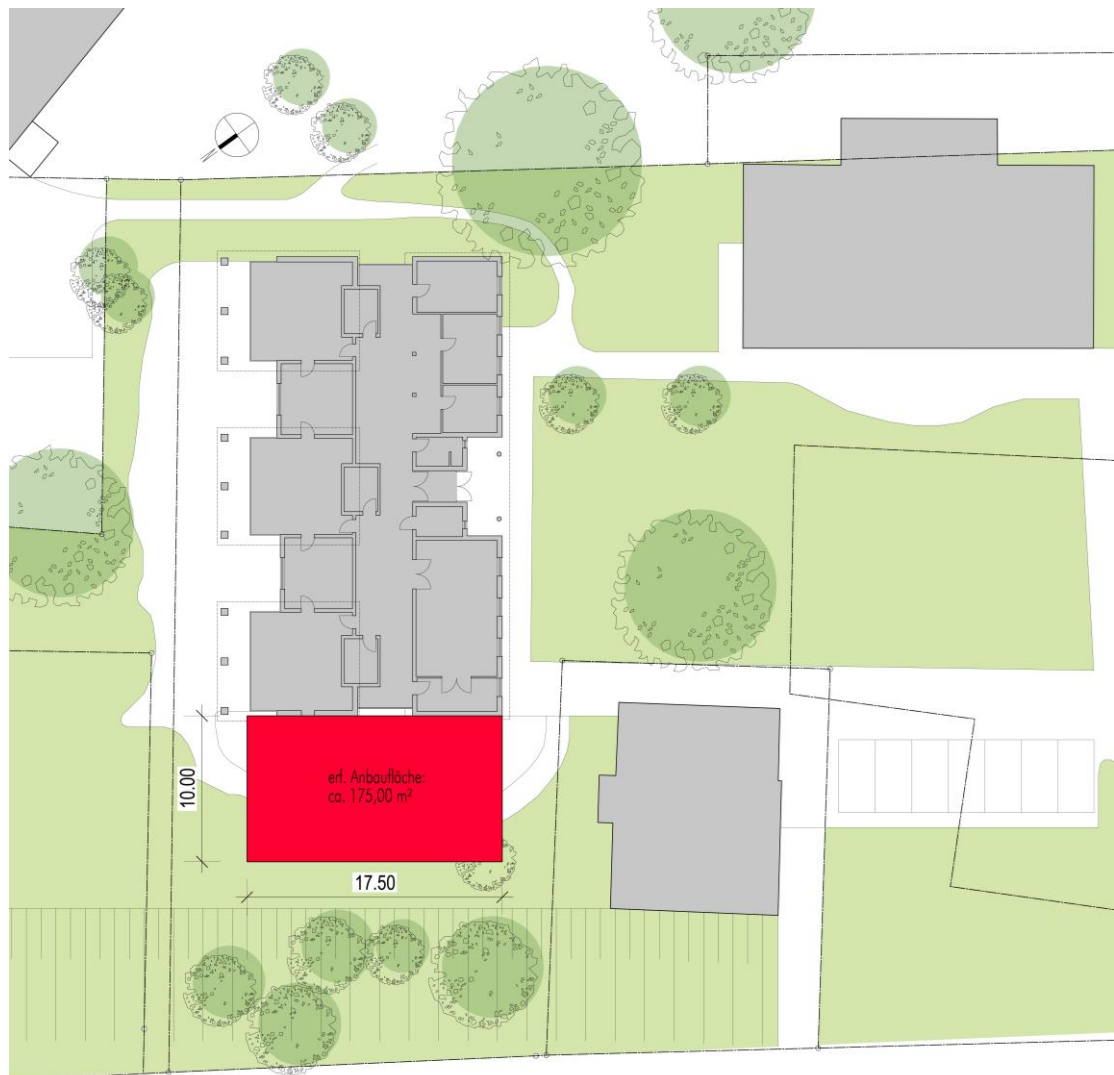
Lageplan mit Eintragung der erforderlichen Anbaufläche
